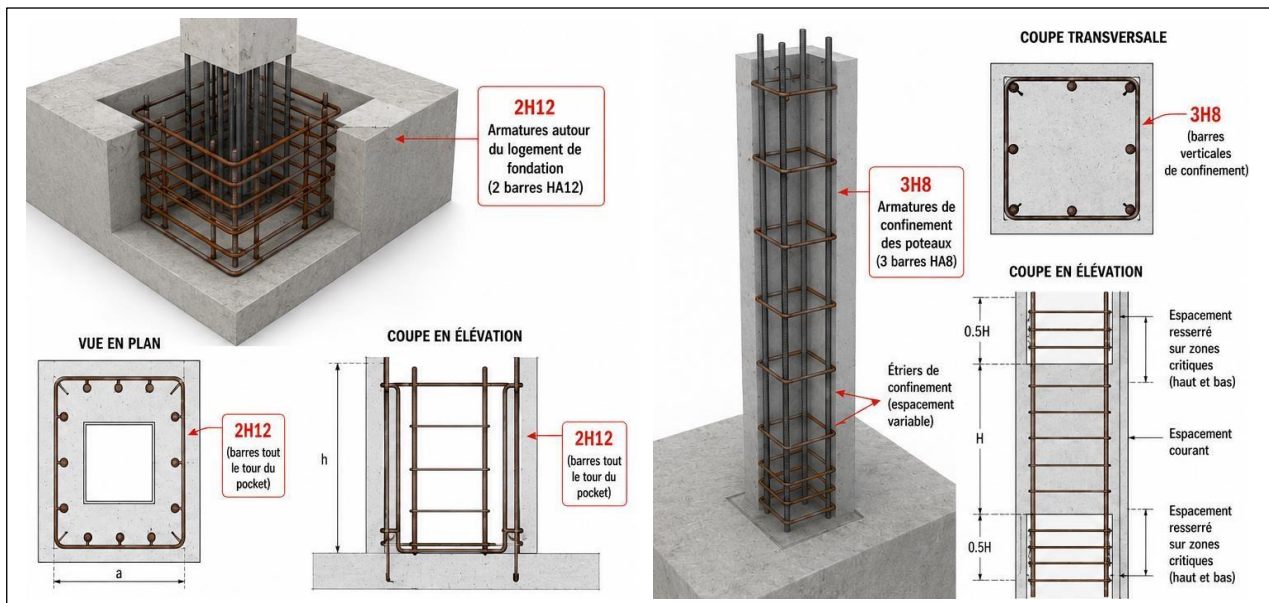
Détail des armatures de confinement des poteaux et du logement de fondation dans les structures préfabriquées.
